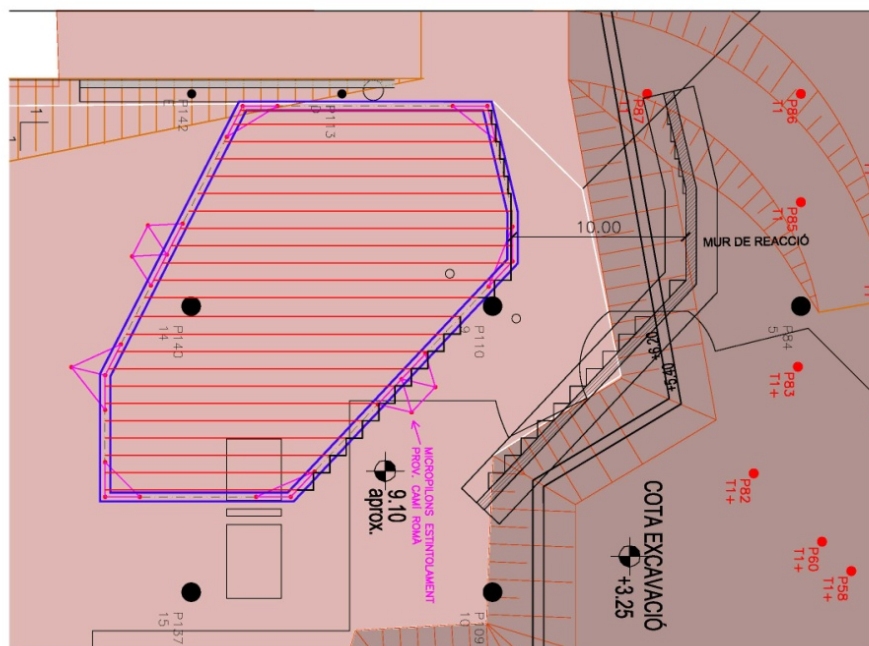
Planta de la zona acondicionada para la hinca de los tubos cuadrados huecos
